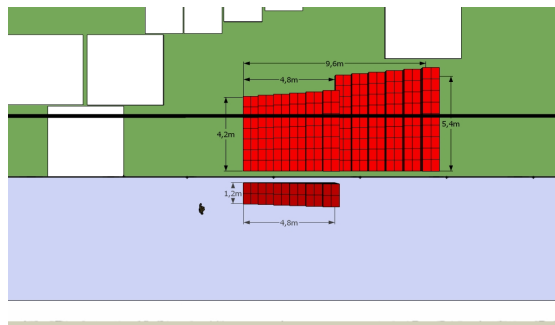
Hipótese de construção, vista aérea 3d (executado em *SketchUp*).
